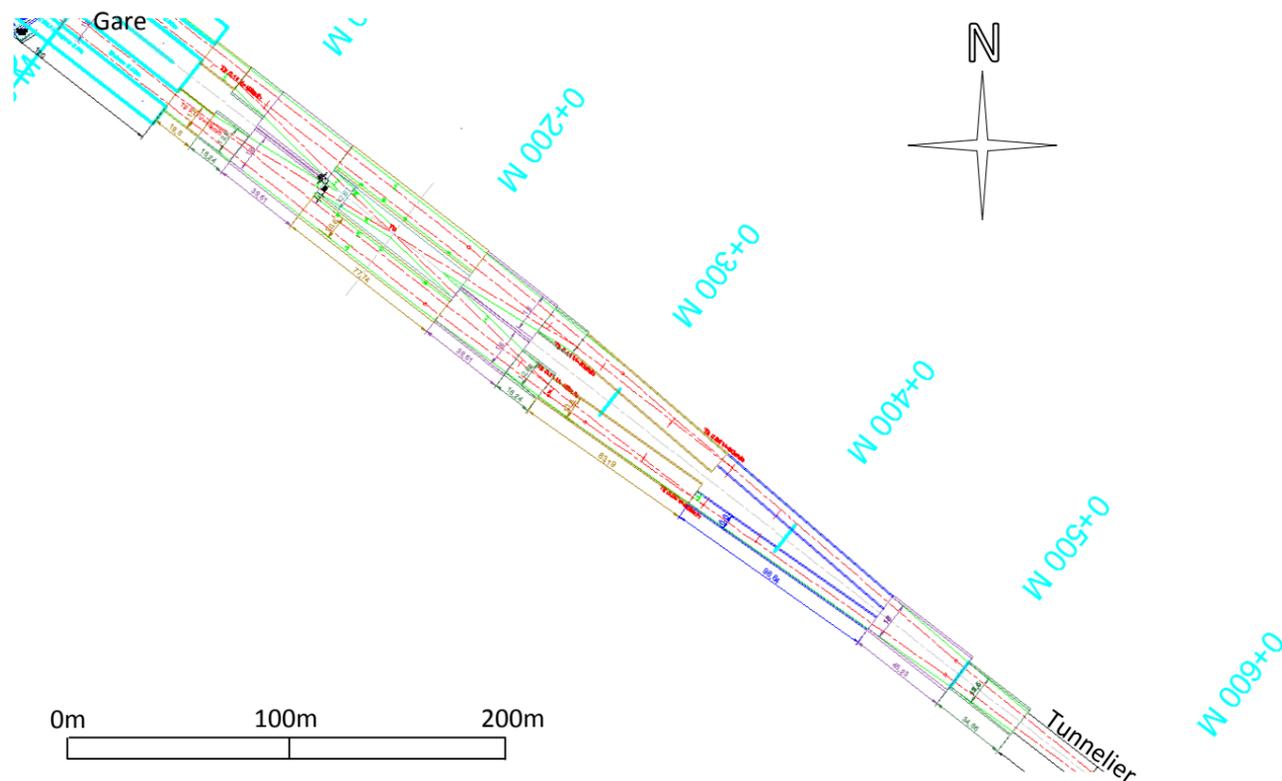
Vue en plan de l'entonnement à l'avant-gare sud
